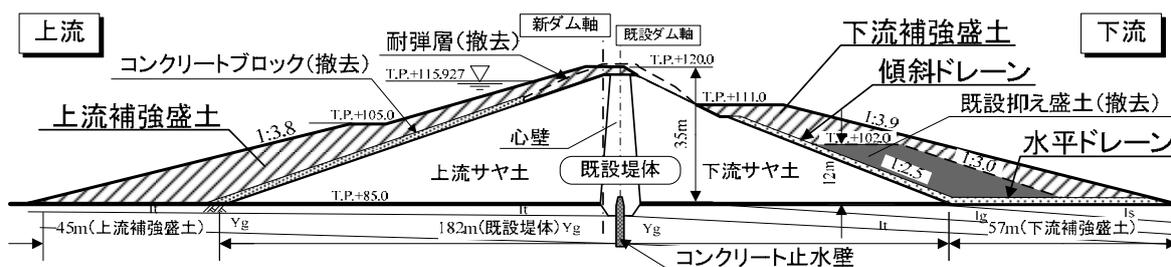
山口貯水池堤体強化工事標準断面図 ²⁻⁷⁾
